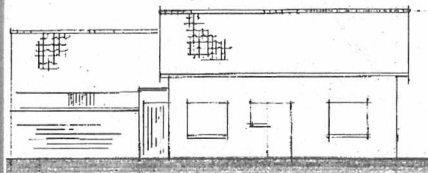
Plangebied vooranzicht Scheidingstraat 5, Eede. (westen)
